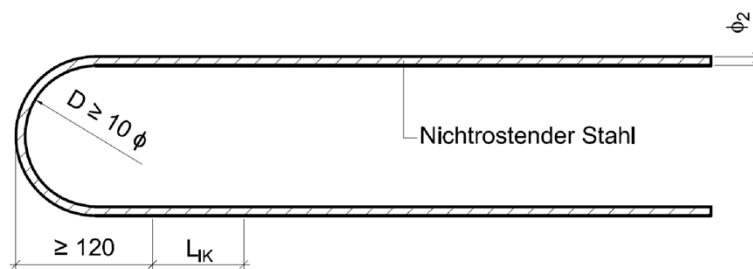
Zugstab für Schöck Isokorb® Typ A und Typ F
